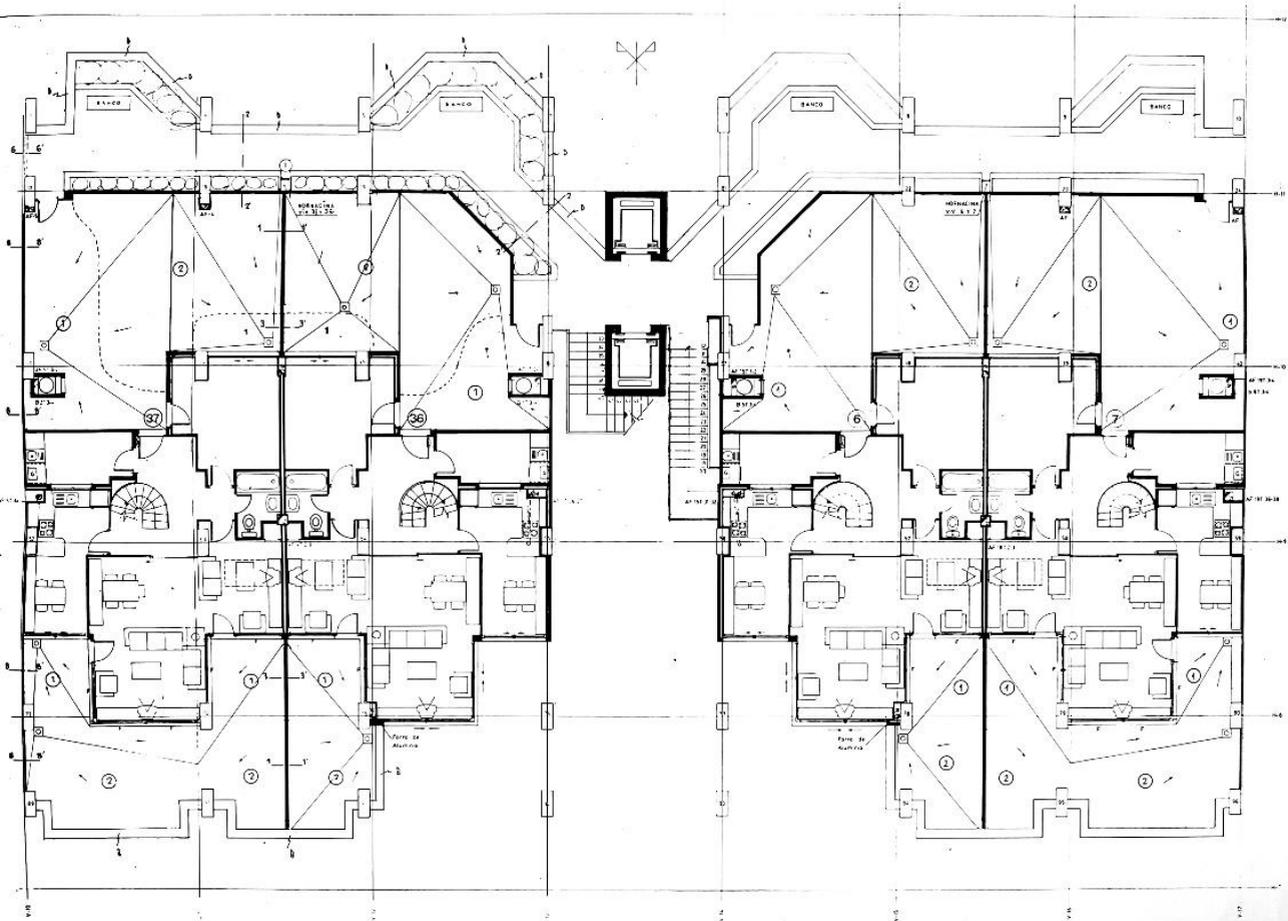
Distribución parte central de la 2ª planta con la trama. Fuente: Archivo personal de Cortés.
